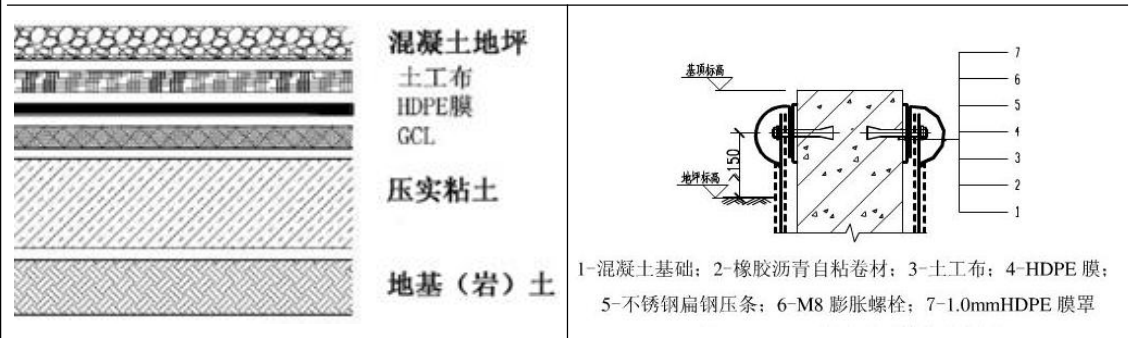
设计 HDPE 模单层防渗结构示意图	图 4-5 HDPE 模与基础连接示意图
